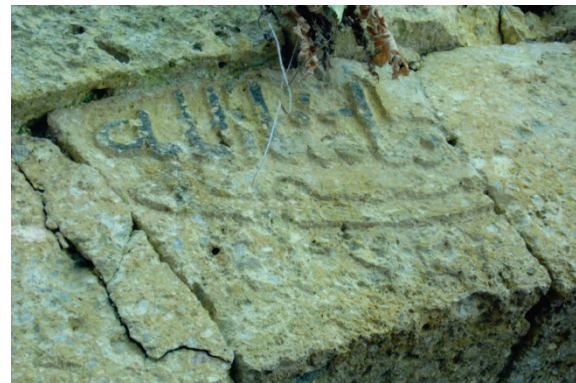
Yeşildere Köprüsü Döşemesi
